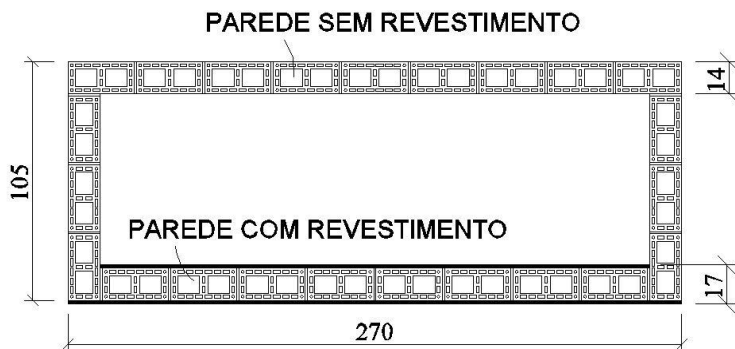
Disposição das paredes sem preenchimento, em planta.
